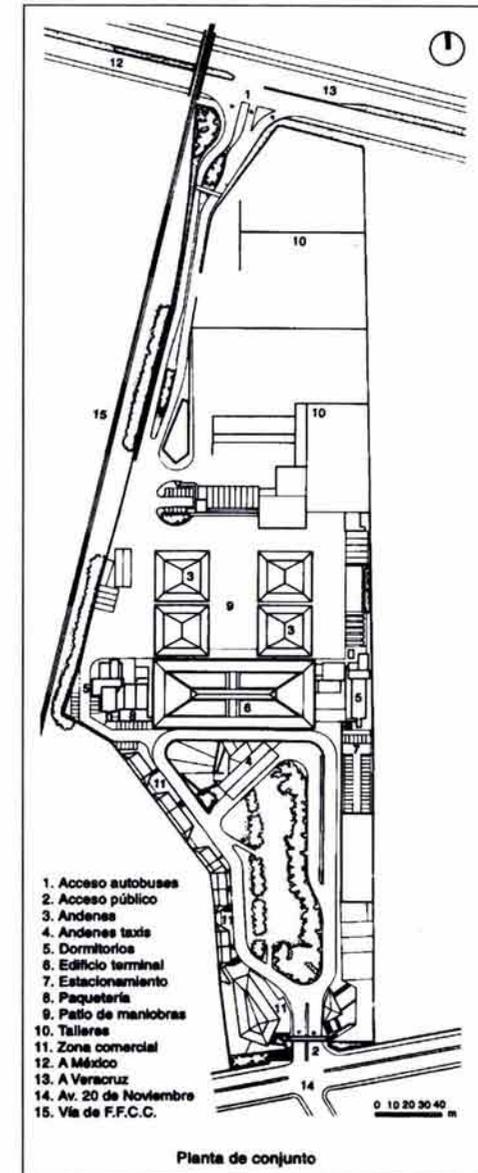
PLANTA DE CONJUNTO TERMINAL DE XALAPA (CAXA)
